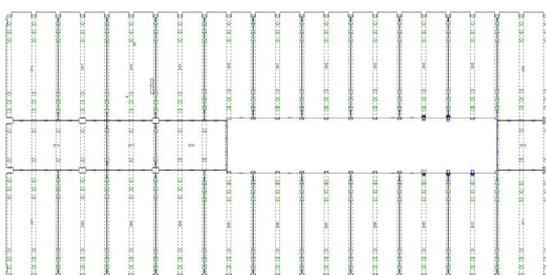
Grundriss des Referenzobjektes mit vorgefertigten Wilma Betonelementen
